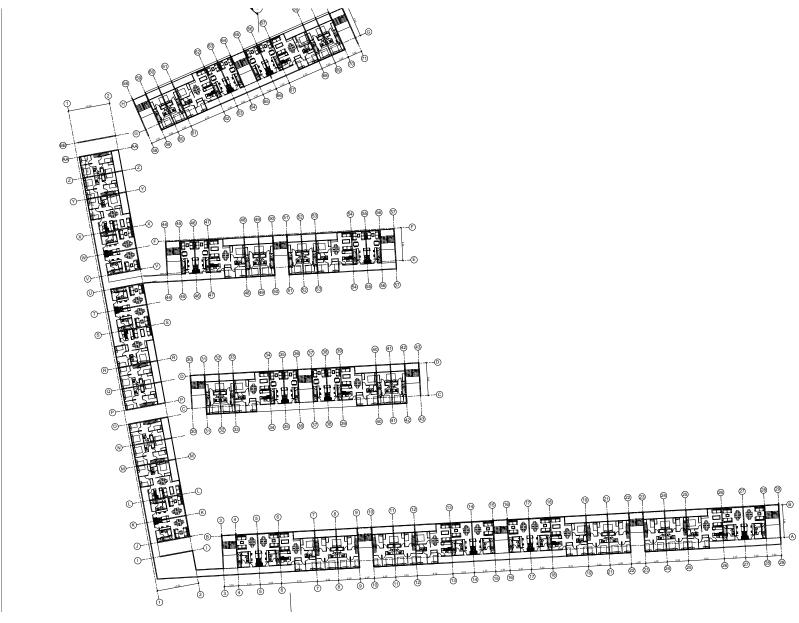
Planta Tipo pisos 3, 5, 7 y 9.
